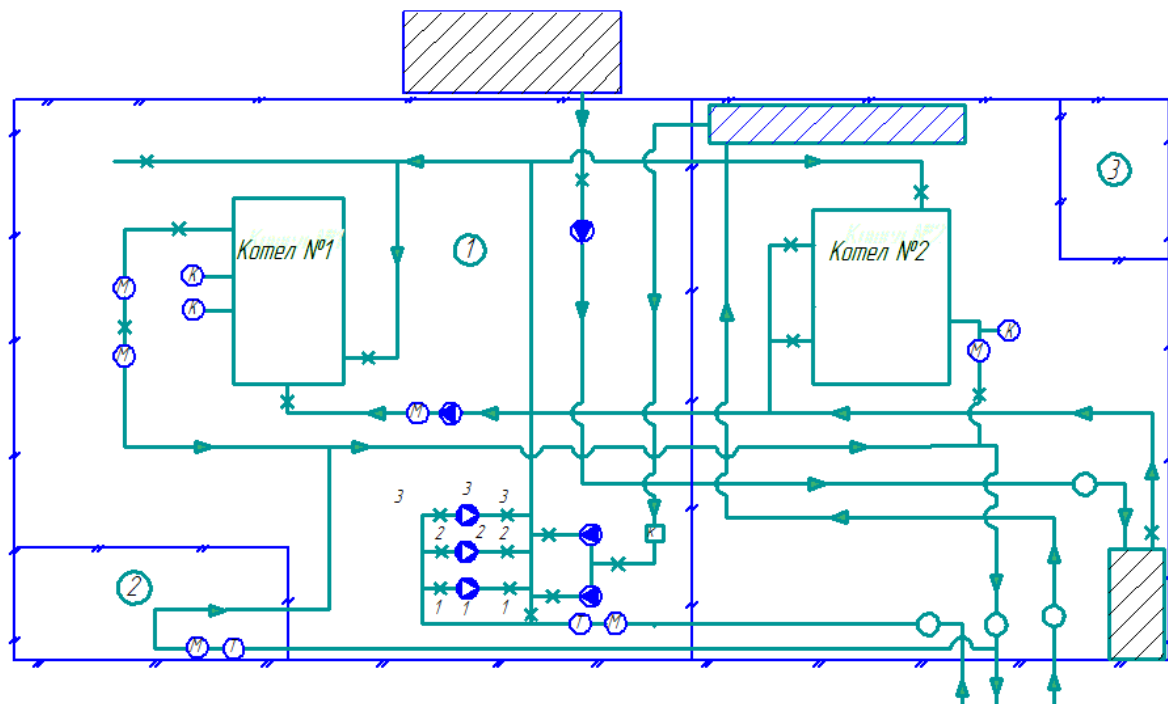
Тепловая схема котельной № 2: 1 – котельное помещение; 2 – операторная; 3 – слесарная
